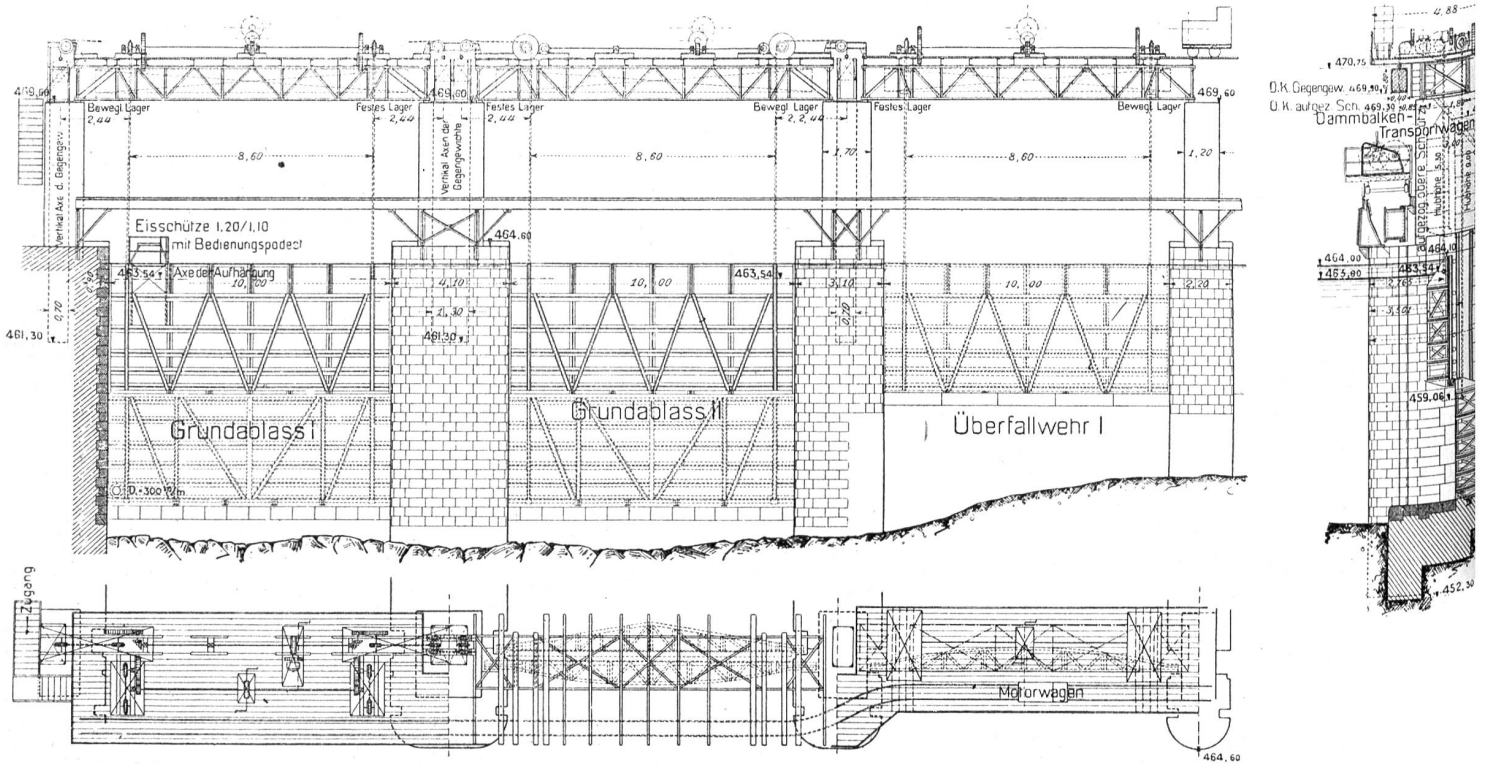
Ansicht vom Oberwasser aus und Grundriss der 3 ersten Schützen. Maßstab 1 : 250.
